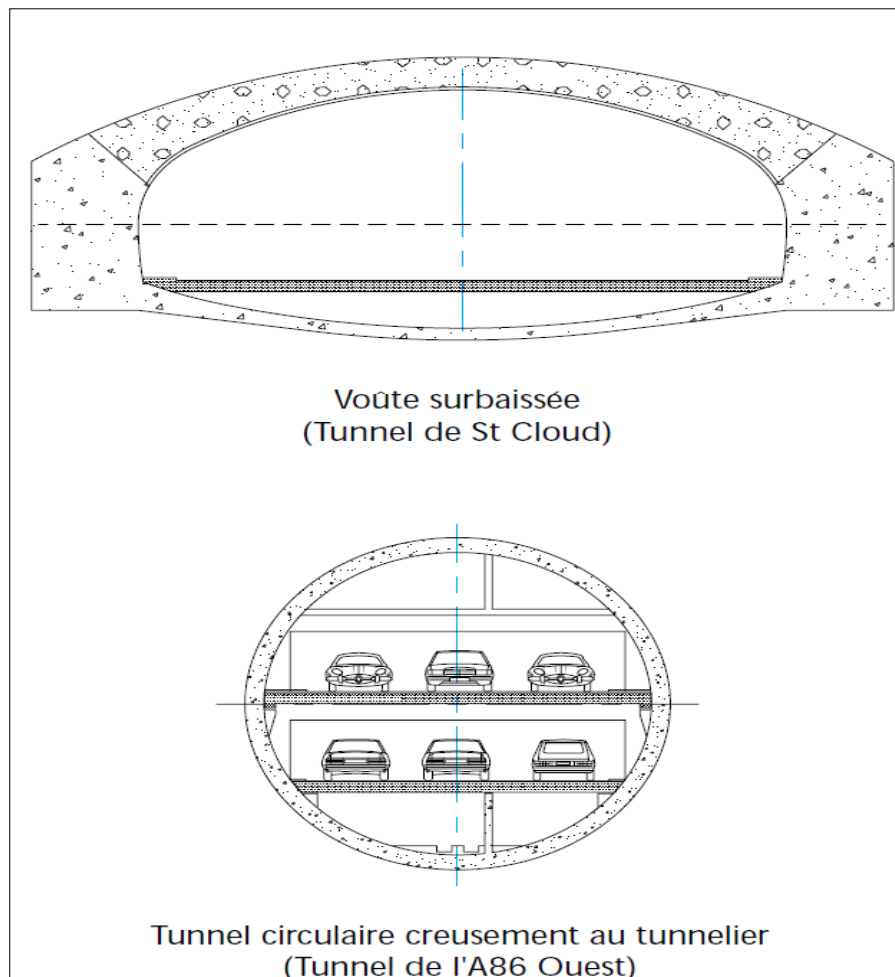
Profil en travers d'un tunnel routier (CETU3, 1998).
